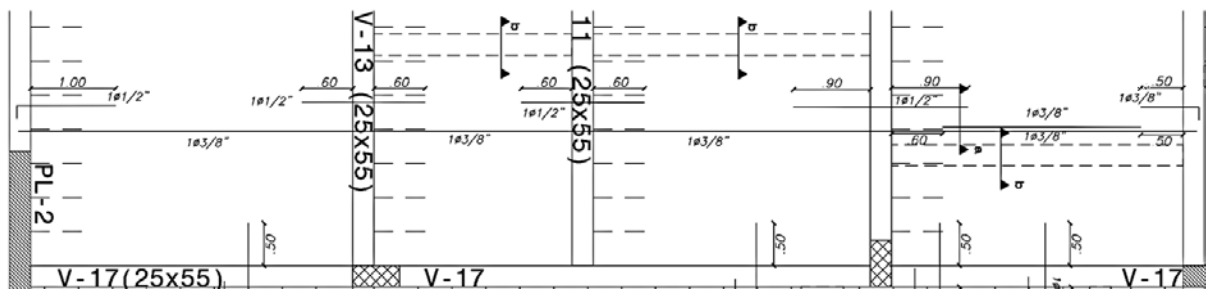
Planta con refuerzo de diseño de losa aligerada tramo eje G-C/2-3
